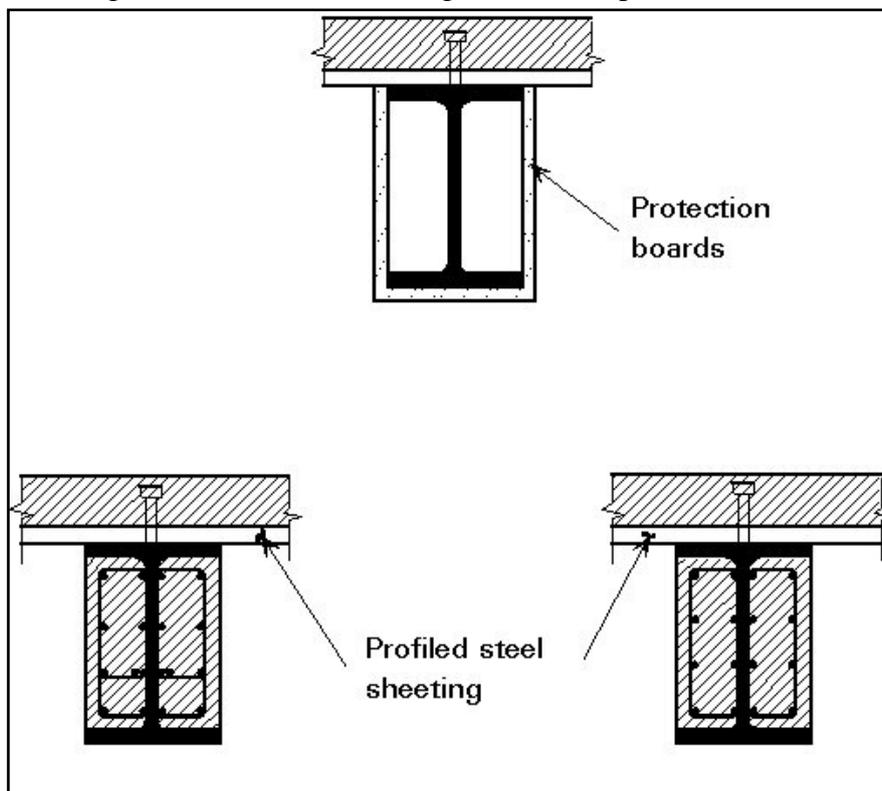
poutres mixtes partiellement enrobées de béton (figures de bas) et poutres mixtes avec protection conventionnelle faite de panneaux (figure de haut).
